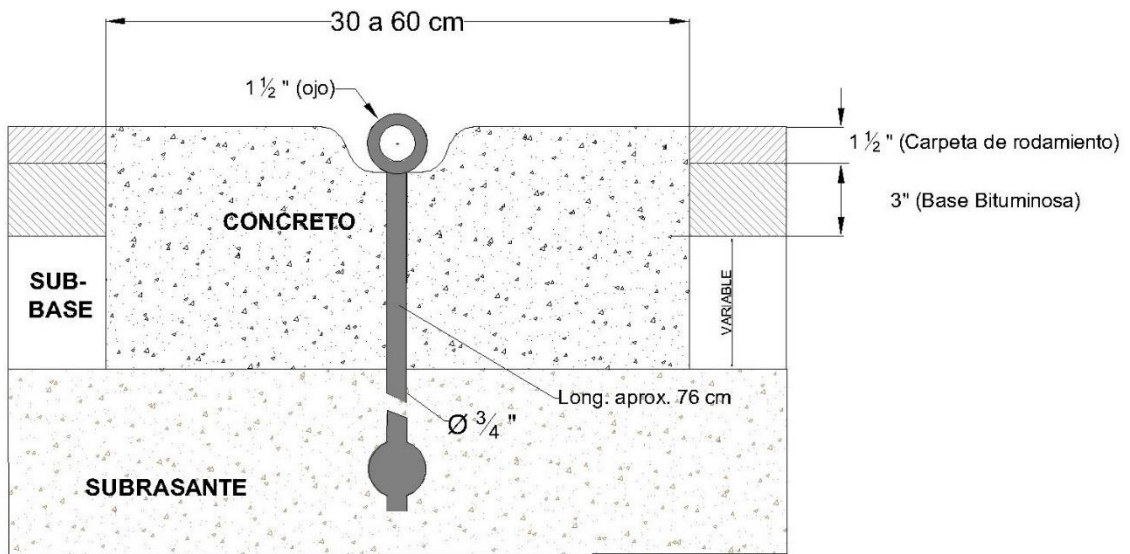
Dispositivos fijos de amarre para superficies de pavimento flexible.
